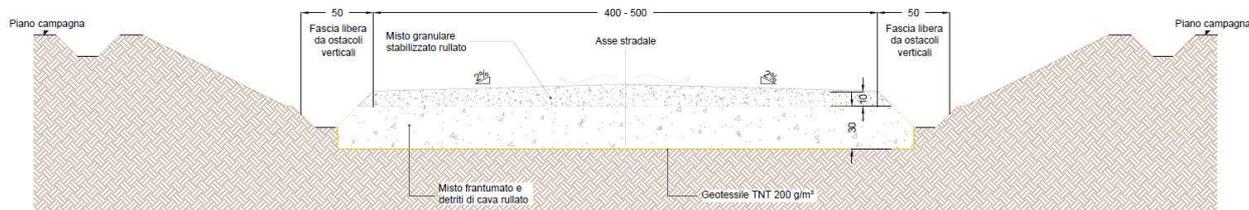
Sezione tipo pista di impianto in trincea; misure in centimetri.
